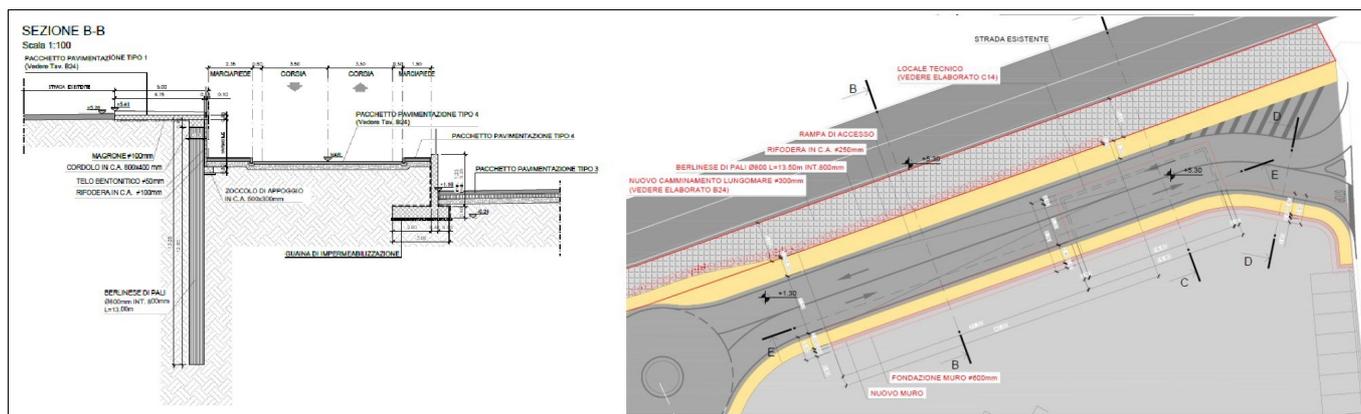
Rampa di collegamento tra area portuale e rampa esistente
